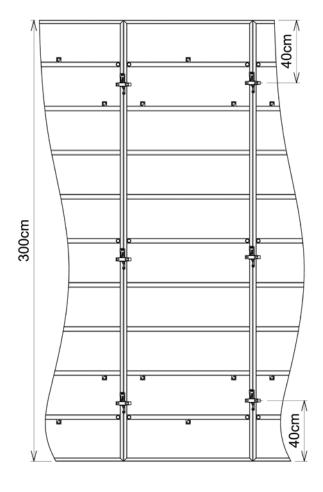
Positionnement des serrures sur une hauteur 3,00 m
